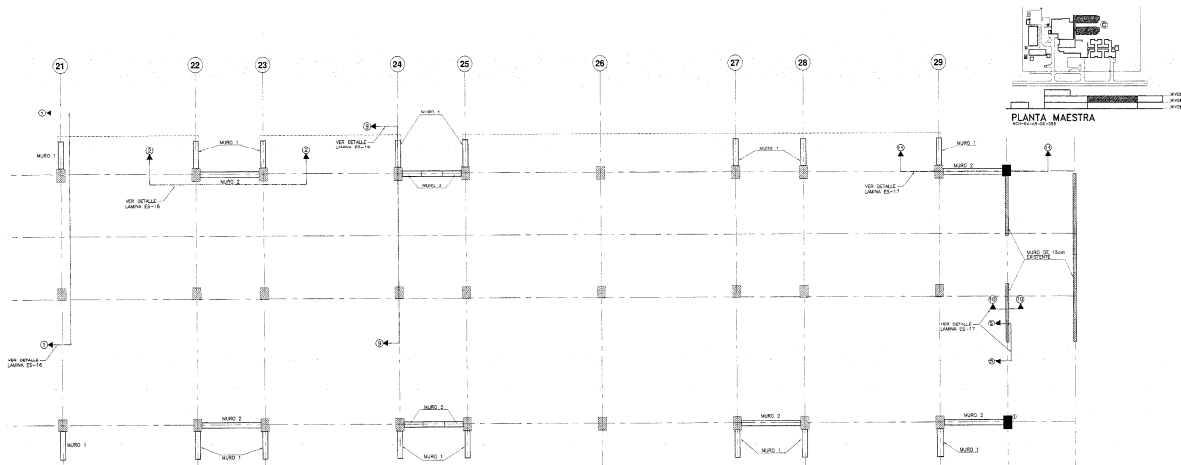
Planta de muros incorporados de edificio reforzado.
